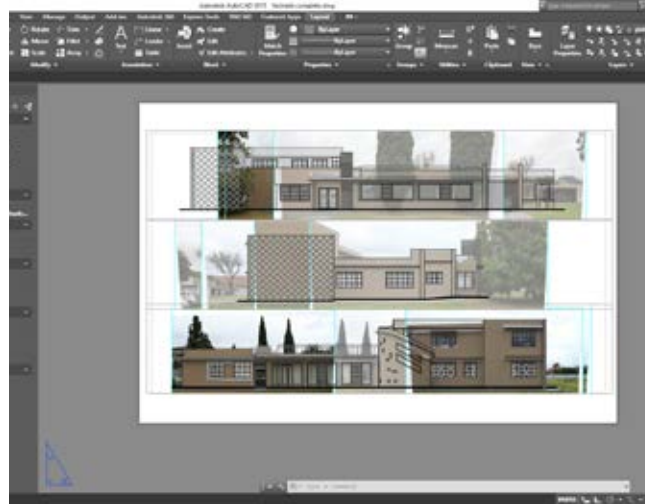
Redibujo de fachadas sobre imágenes rectificadas.
